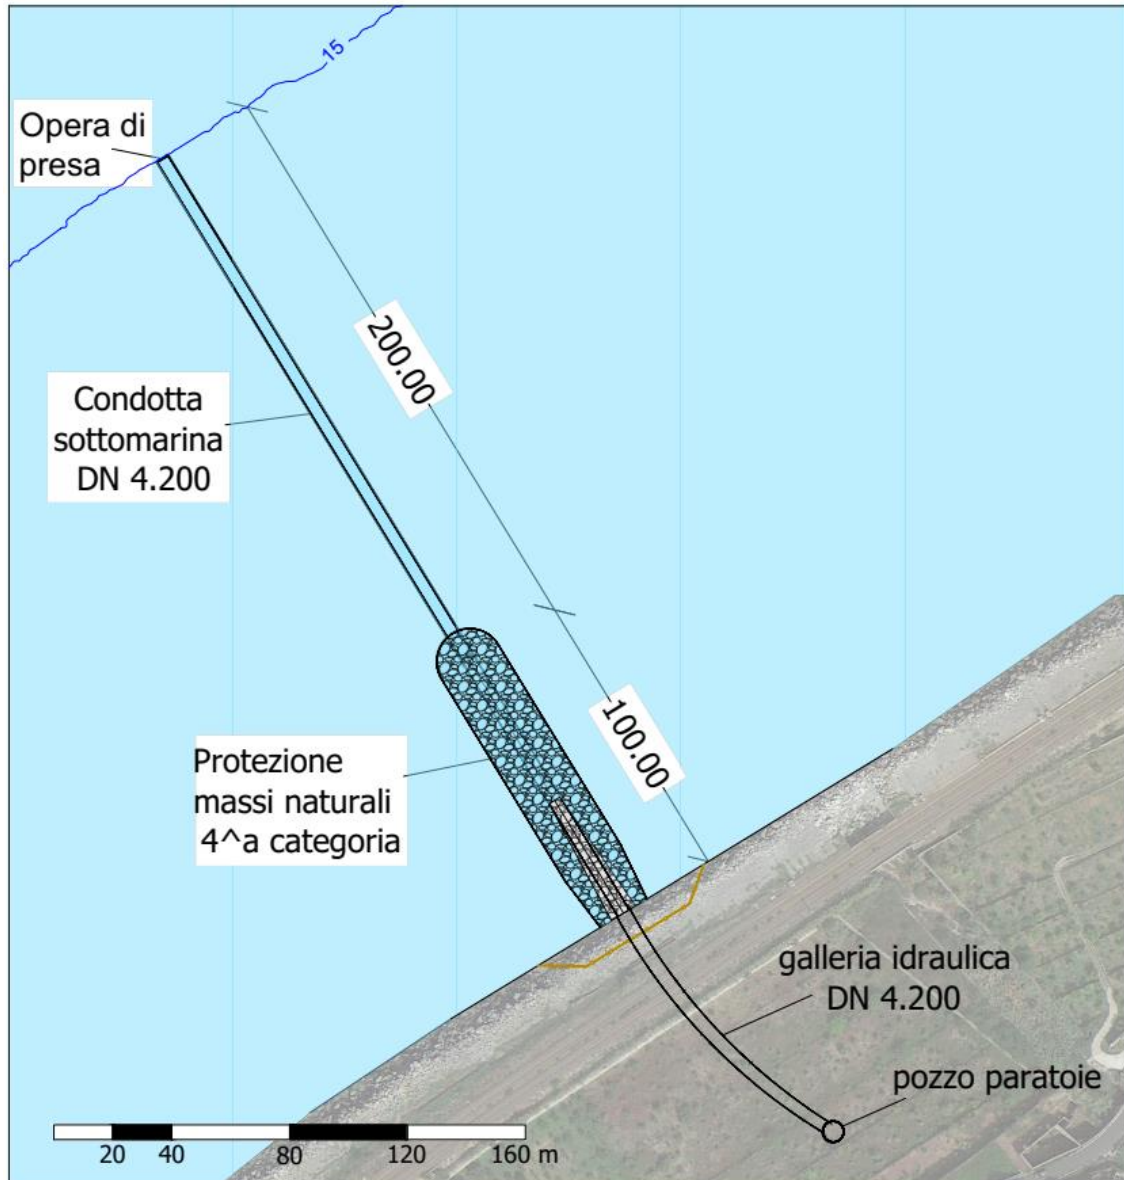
Planimetria dell'opera di presa – Soluzione B
